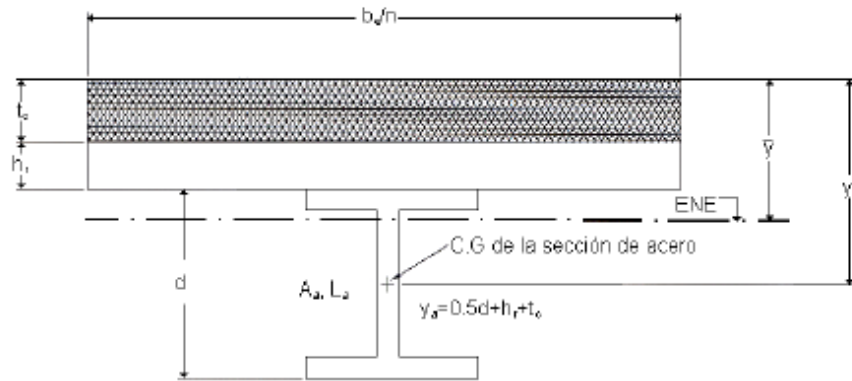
Eje neutro elástico fuera de la losa de concreto.
